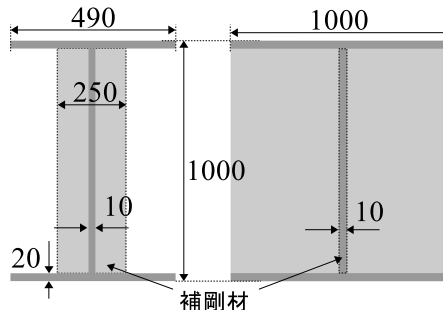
I 形断面の代表体積要素の断面図 (左) と側面図 (右) (単位: mm)
